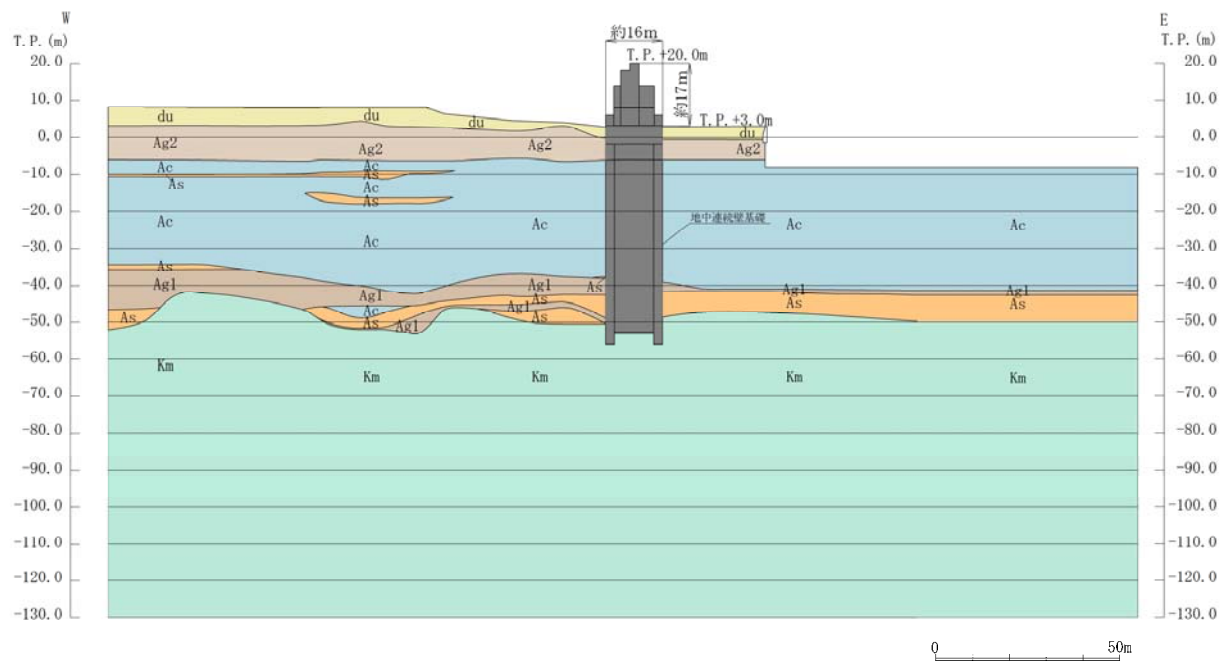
(2) 鋼製防護壁断面図 (②-②断面)
